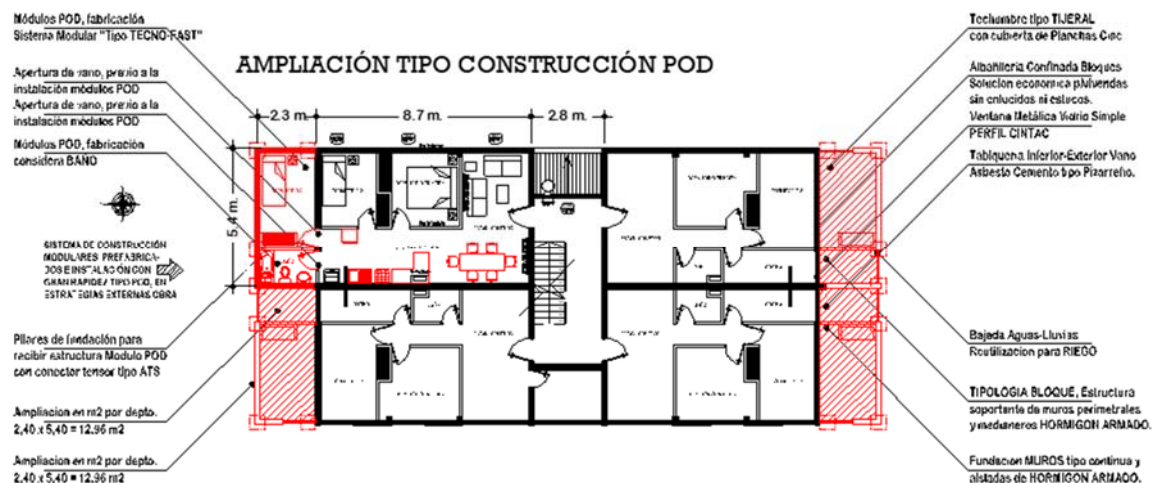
Nueva Planta Distribución, Block 1010, Fuente: Elaboración propia.
